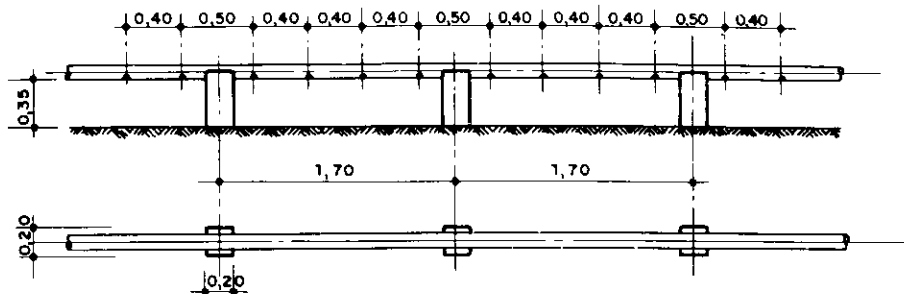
Detalhe dos pilares da tubulação de PVC aérea e furação
